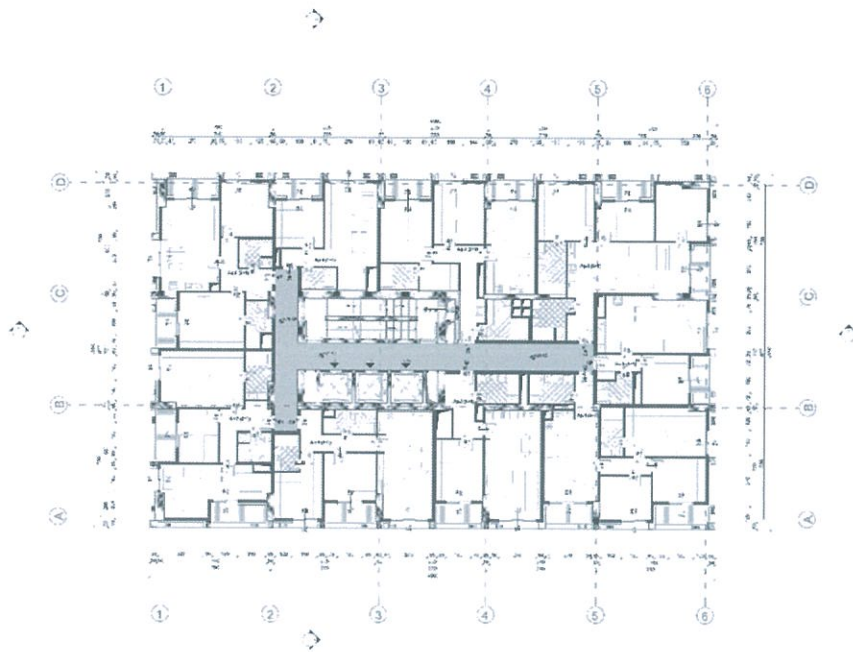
Planimetria e katit +5, +7, +9, +11, +13, +15
